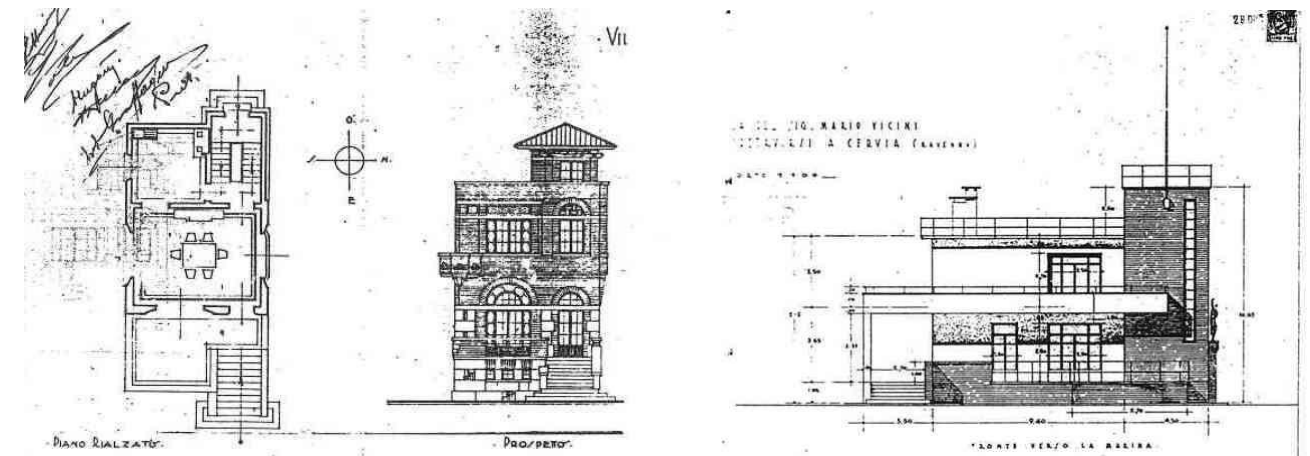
e 100 – Progetti della villa Damerini e della villa Maria dall'Archivio comunale
